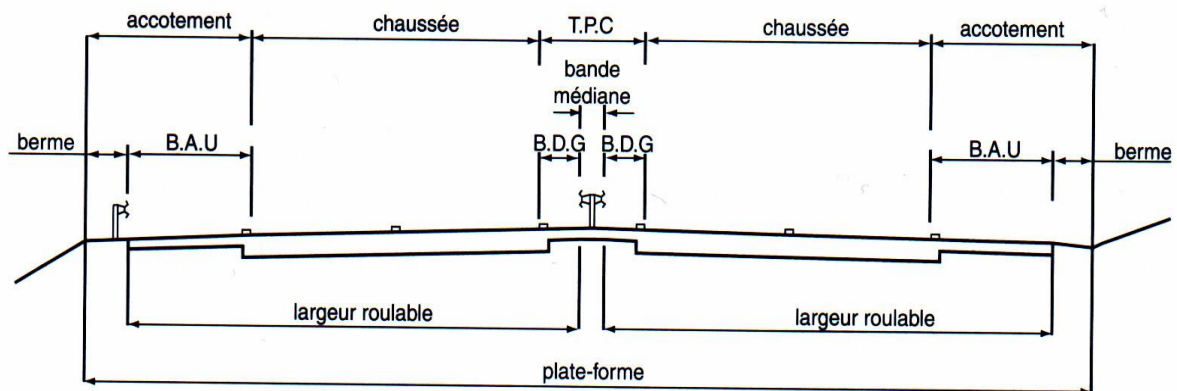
Eléments constructifs du profil en travers d'une autoroute
